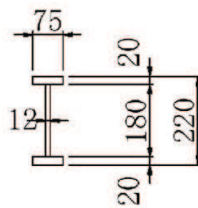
補助縦桁の断面形状 (単位: mm)
